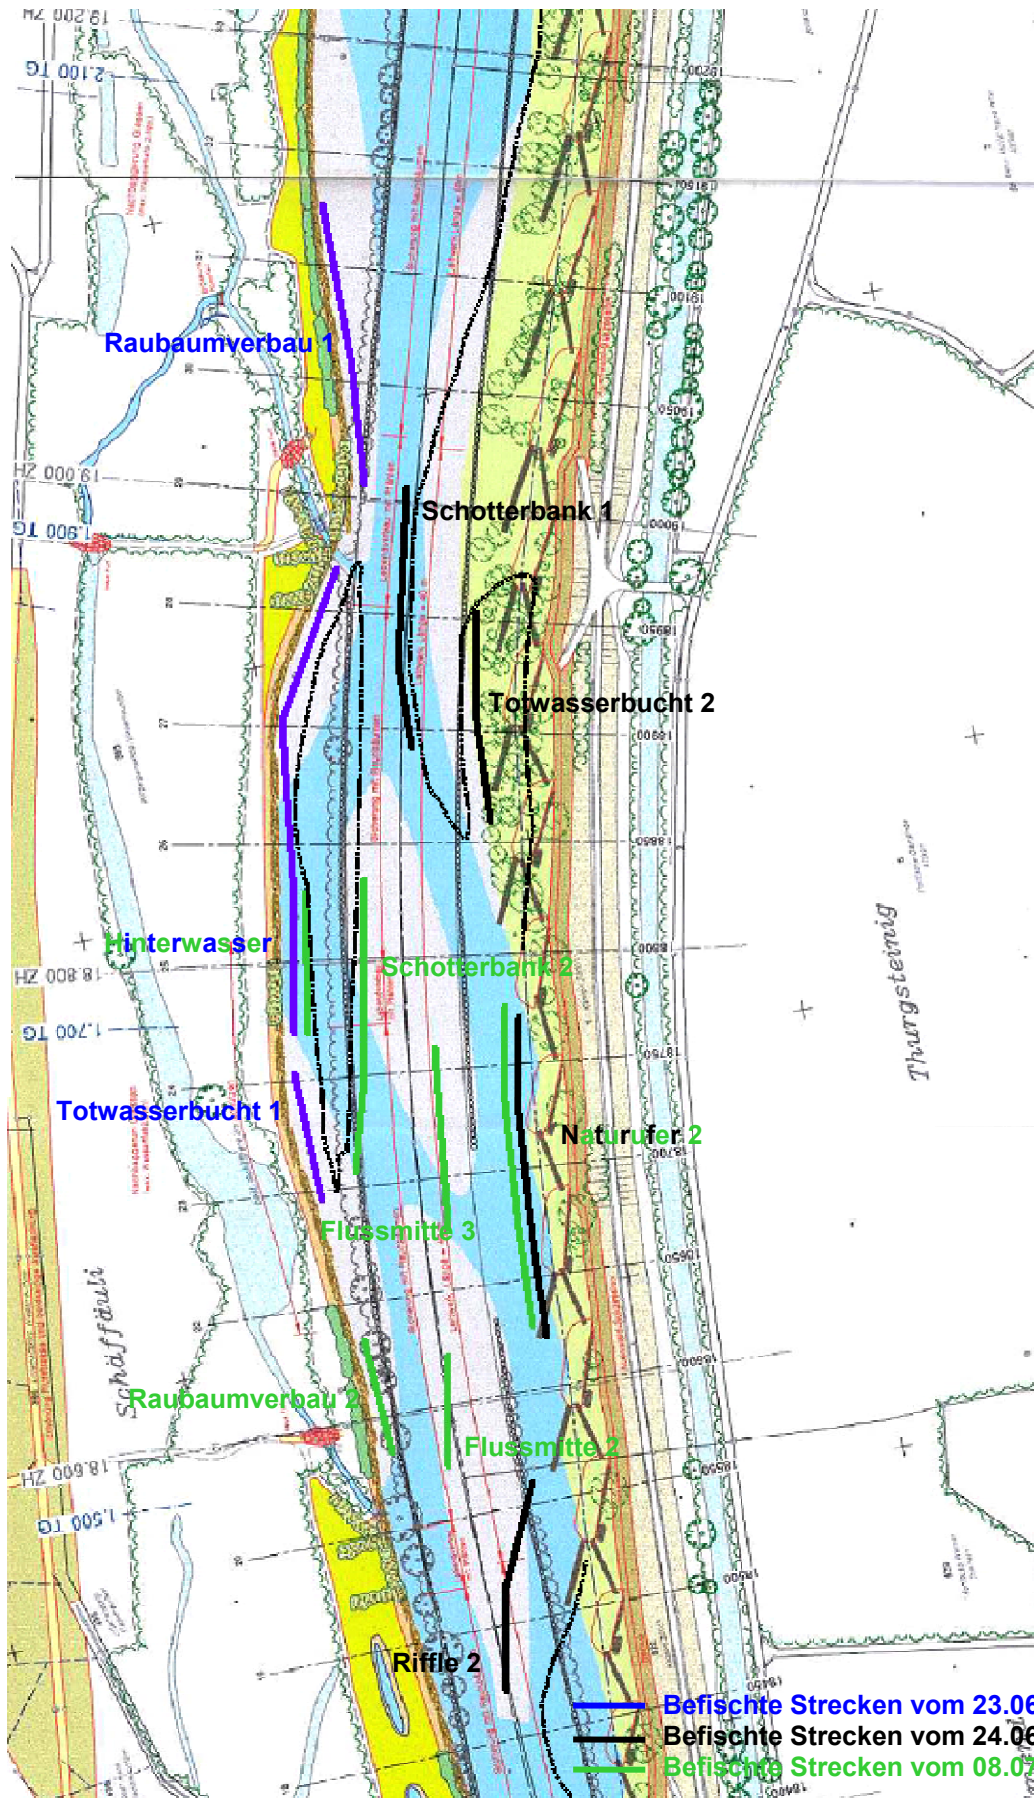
Ausschnitt aus dem Ausführungsplan zur Thurkorrektur Grenze ZH/TG (Fahrhof) - Gem. Üsslingen - Buch, Massstab 1 : 2000, Bauprojekt 1997, Quelle M. Baumann und M. Oplatka
